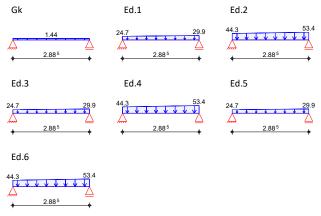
Trapezförmige Belastungen auf Bemessungsniveau
